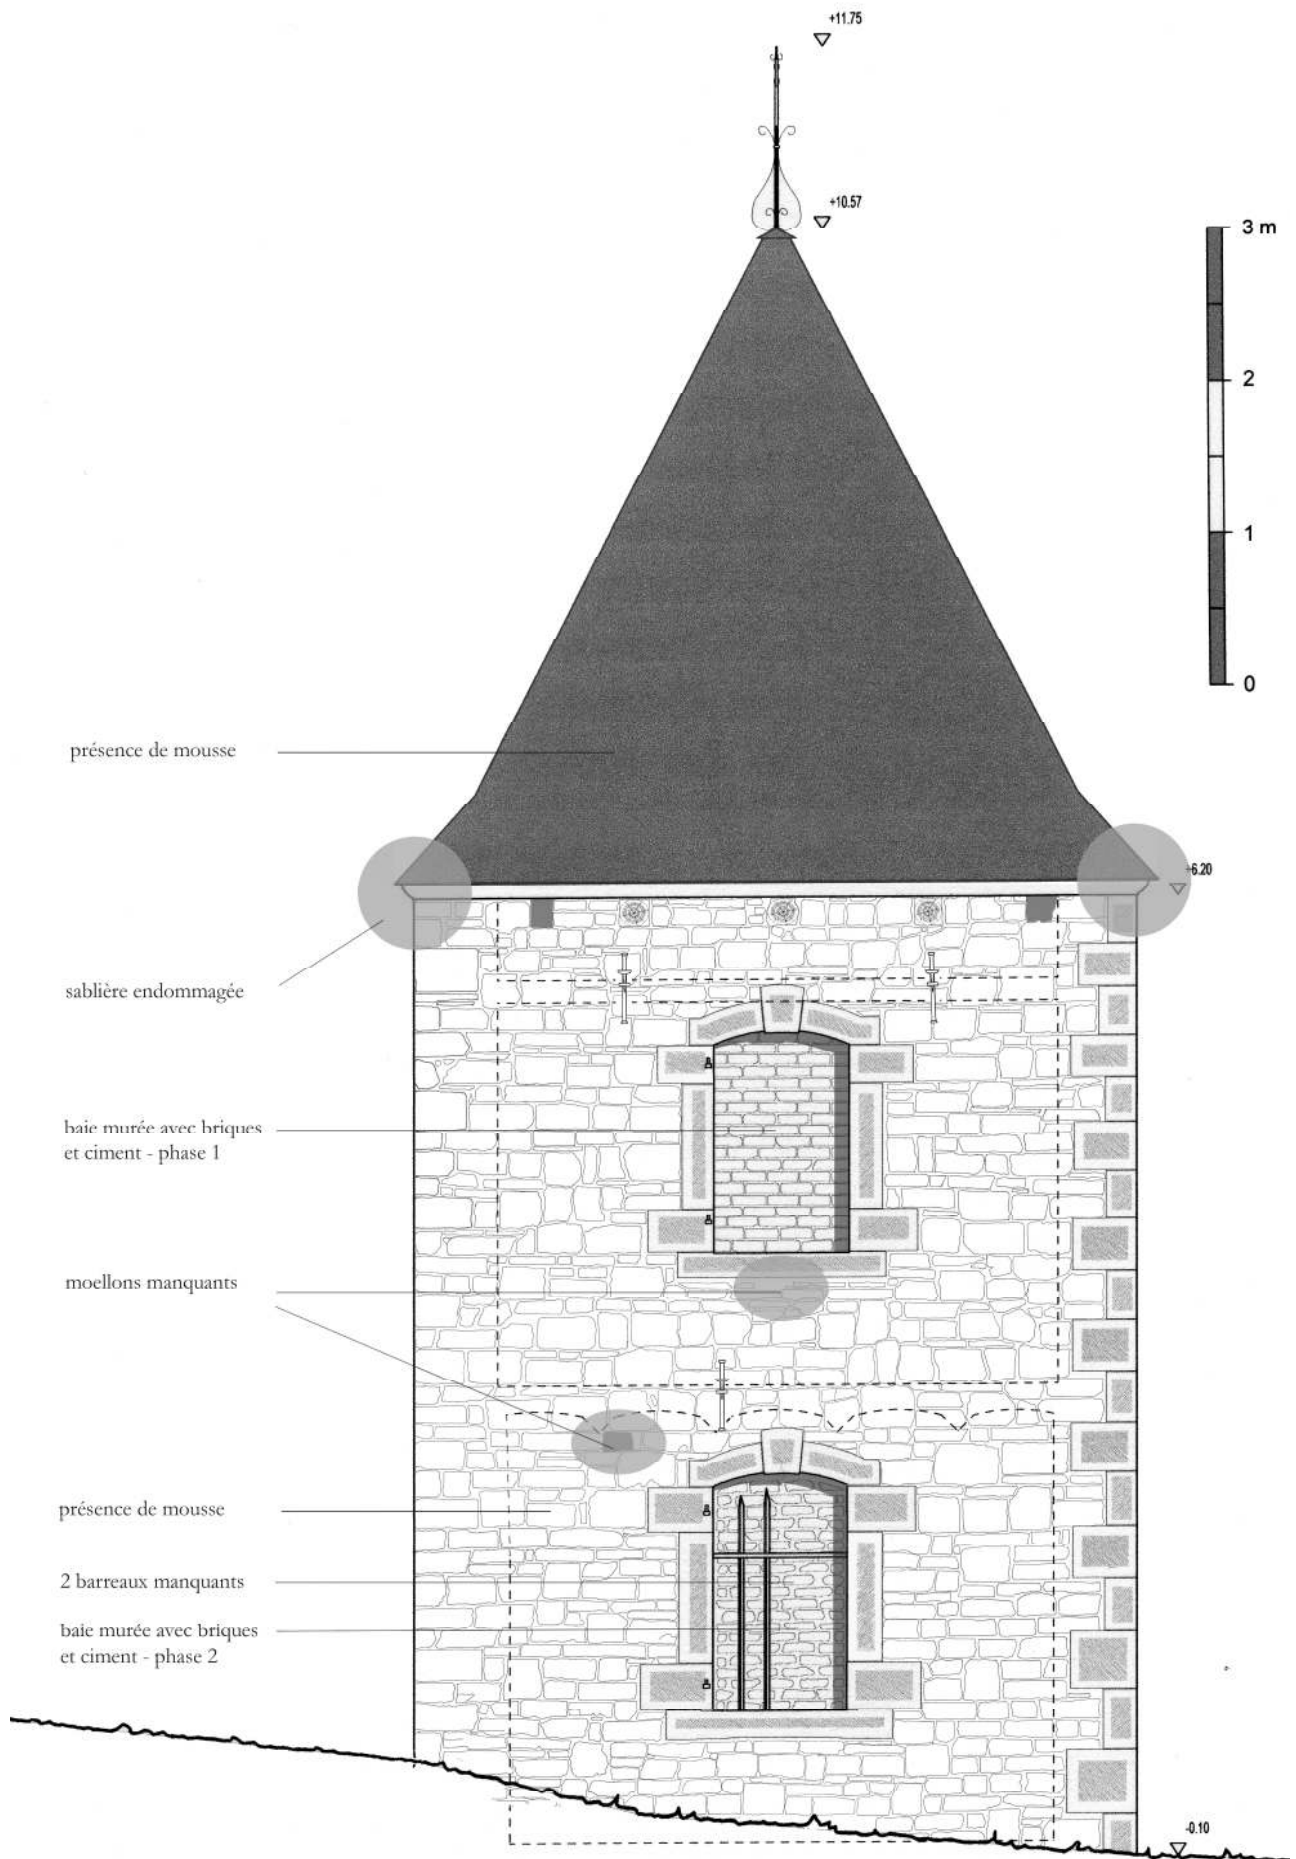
Pavillon. Elévation NE. Ech. 1/50^e. Etat sanitaire. IG 2008.
